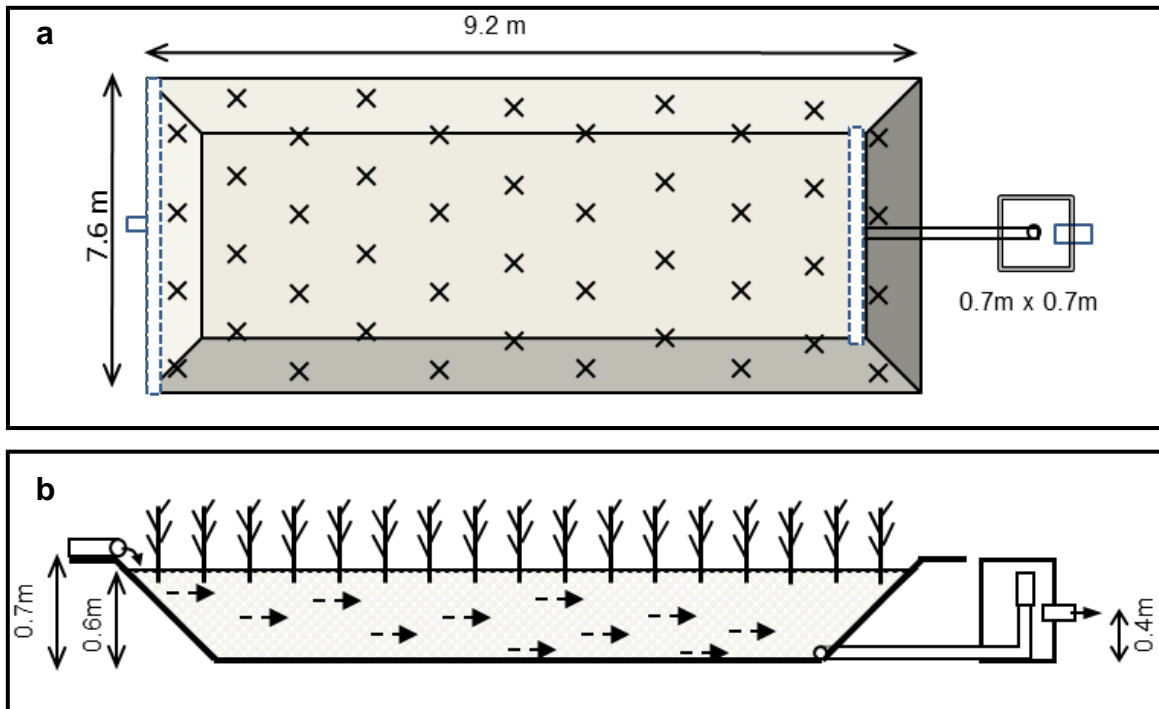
Dimensiones y características del HHFSS a) vista de planta b) vista de corte (Adaptada de la solicitud de patente: MX/a/2010/014332).
